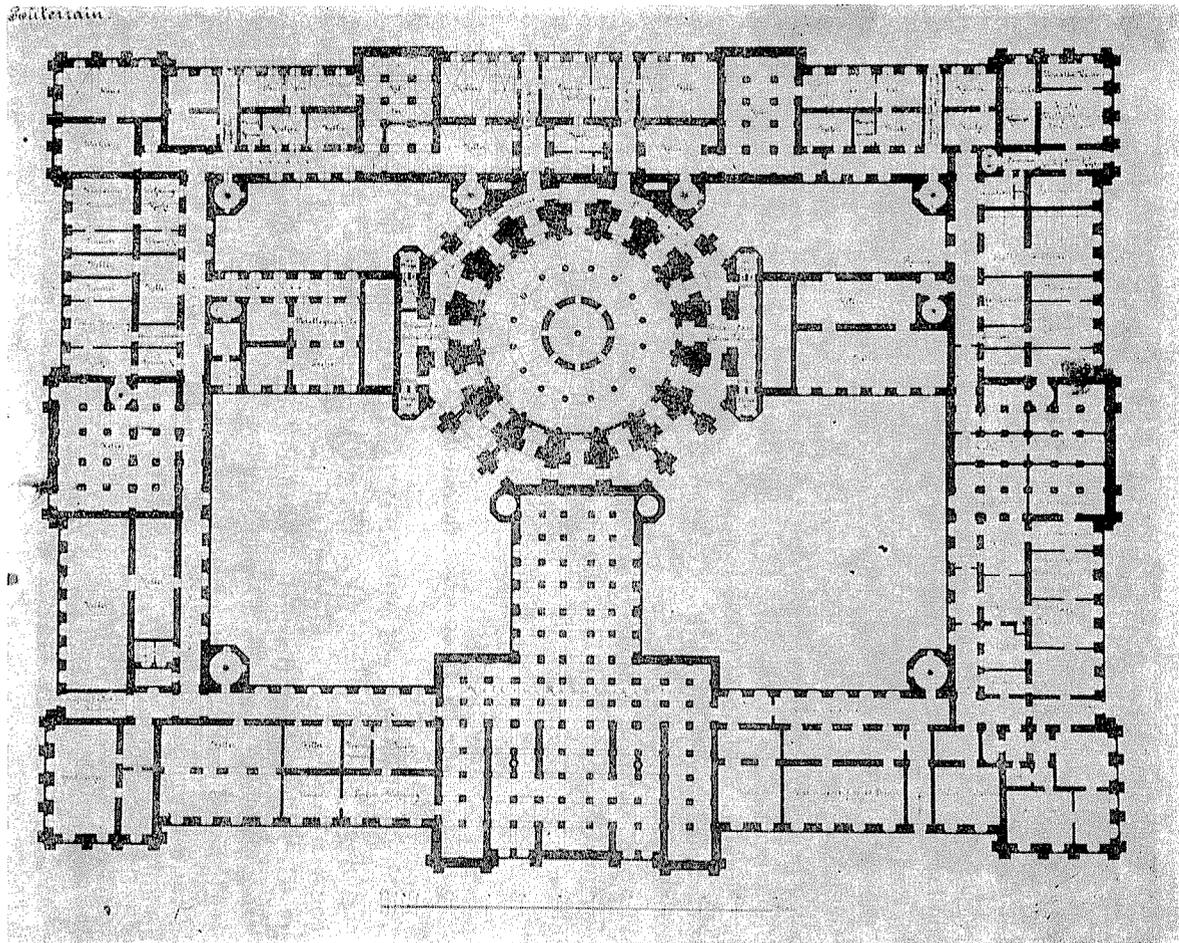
Imre Steindls Entwurf für den ersten Wettbewerb 1872 zu einem Parlamentsgebäude für den Reichstag in Berlin, Grundriß des Souterrains, 1872 (Durch Nr. 4 bezeichnetes Blatt »Souterrain«)
